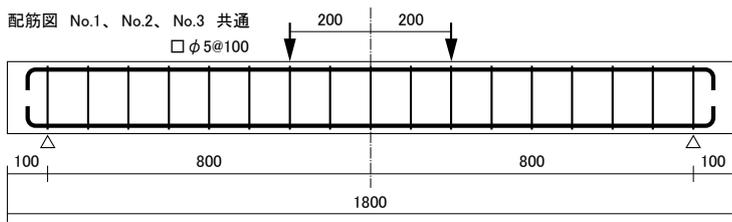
試験体形状・寸法, 配筋, 荷重方法 (梁曲げ試験)
